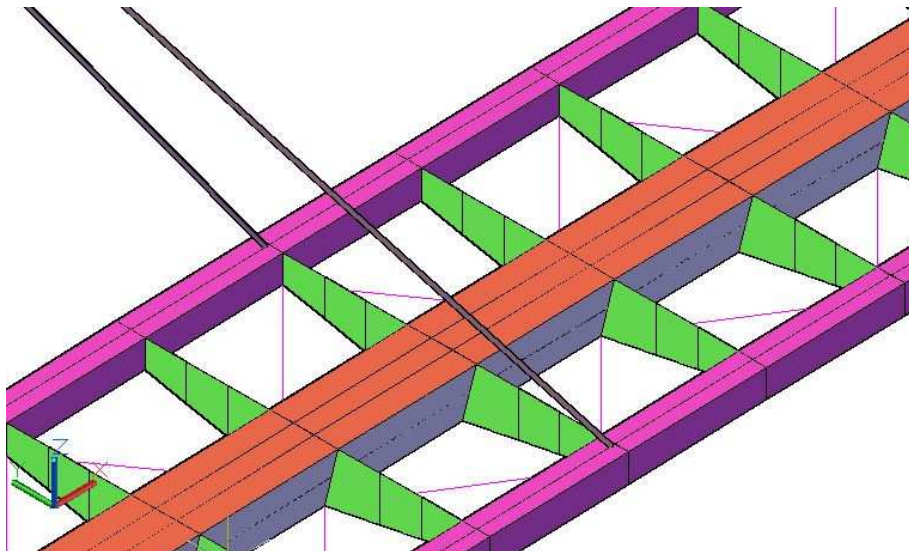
Vista assonometrica del modello tridimensionale dell'impalcato
